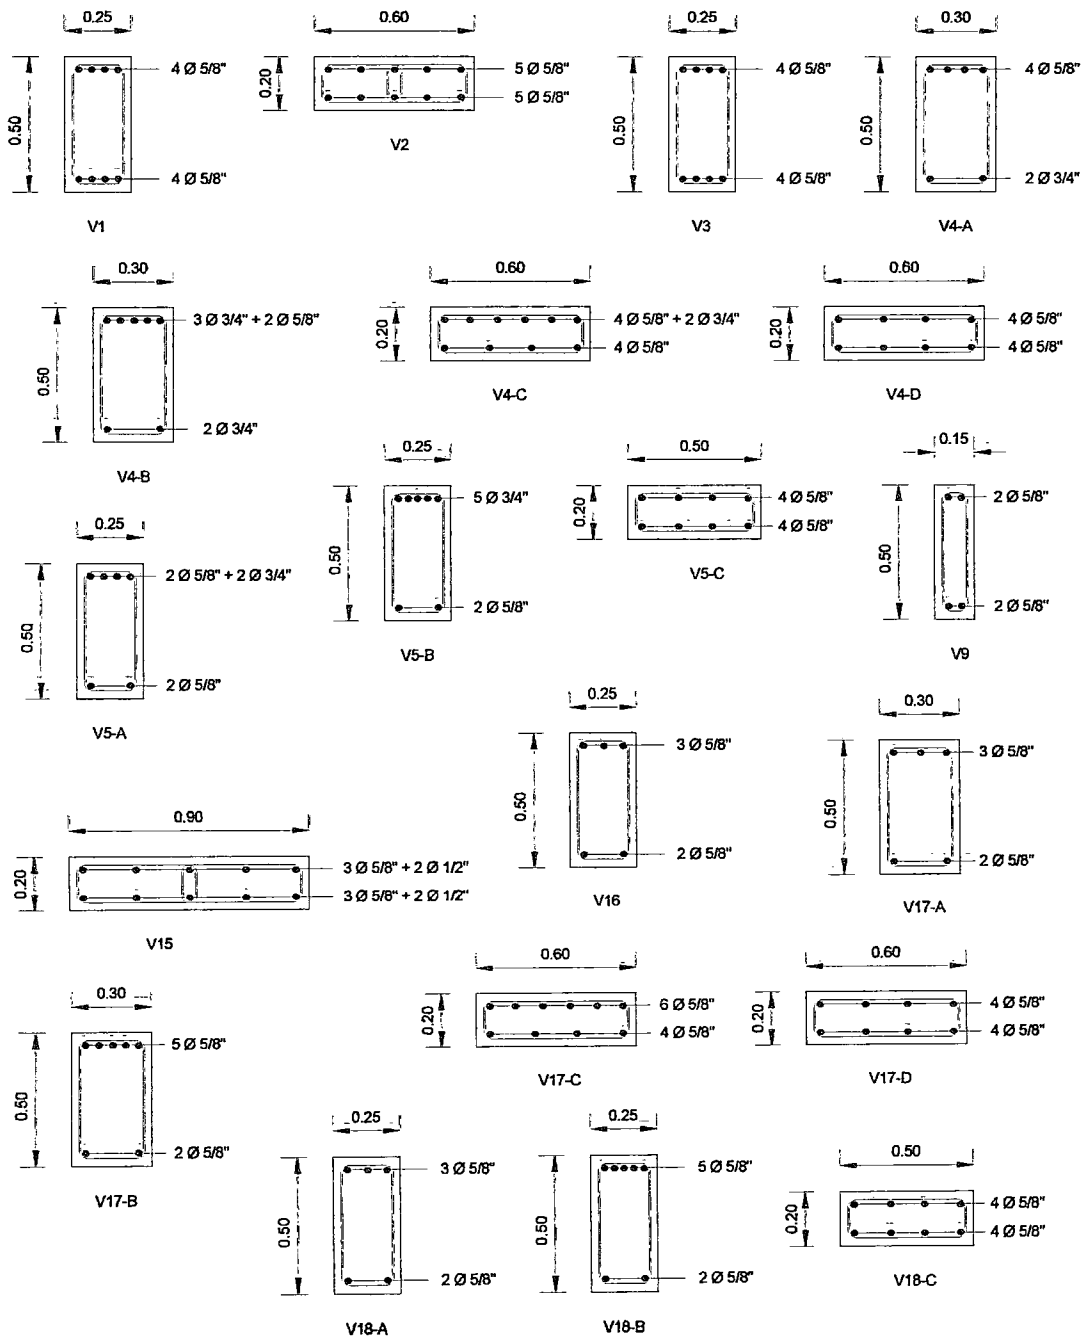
Secciones de vigas del edificio de 7 niveles.
